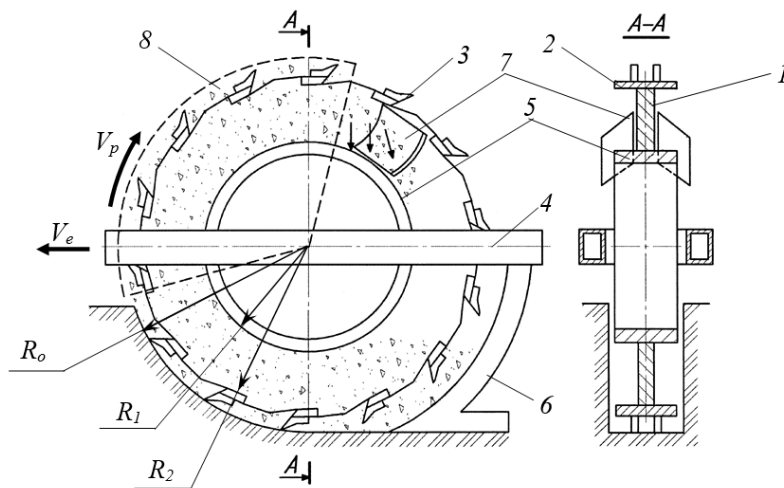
Роторний безківшевий робочий орган: 1 – центральний диск; 2 – траверса; 3 – ріжучий елемент; 4 – рама; 5 – обичайка; 6 – зачисний башмак; 7 – ґрунтознімач; 8 – кожух.
